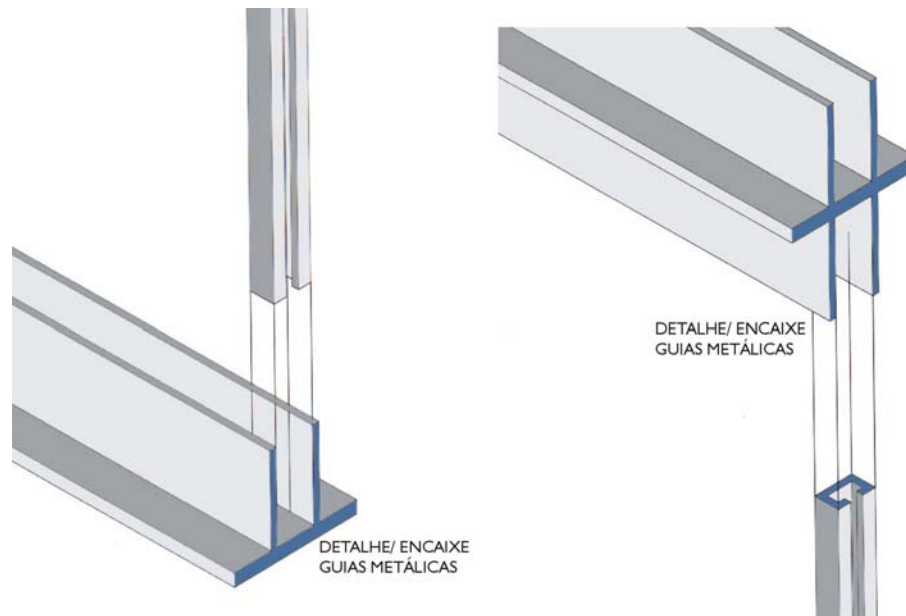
Guias Metálicas dos Painéis de Vedação
